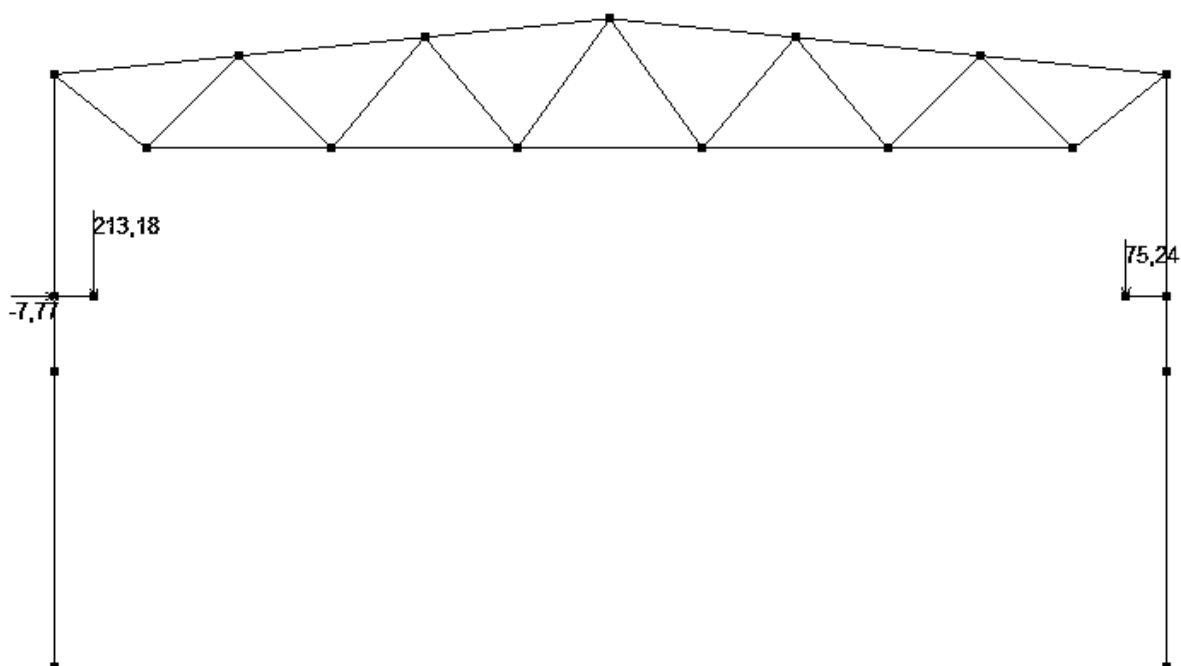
Схема приложения нагрузки от кранового оборудования
